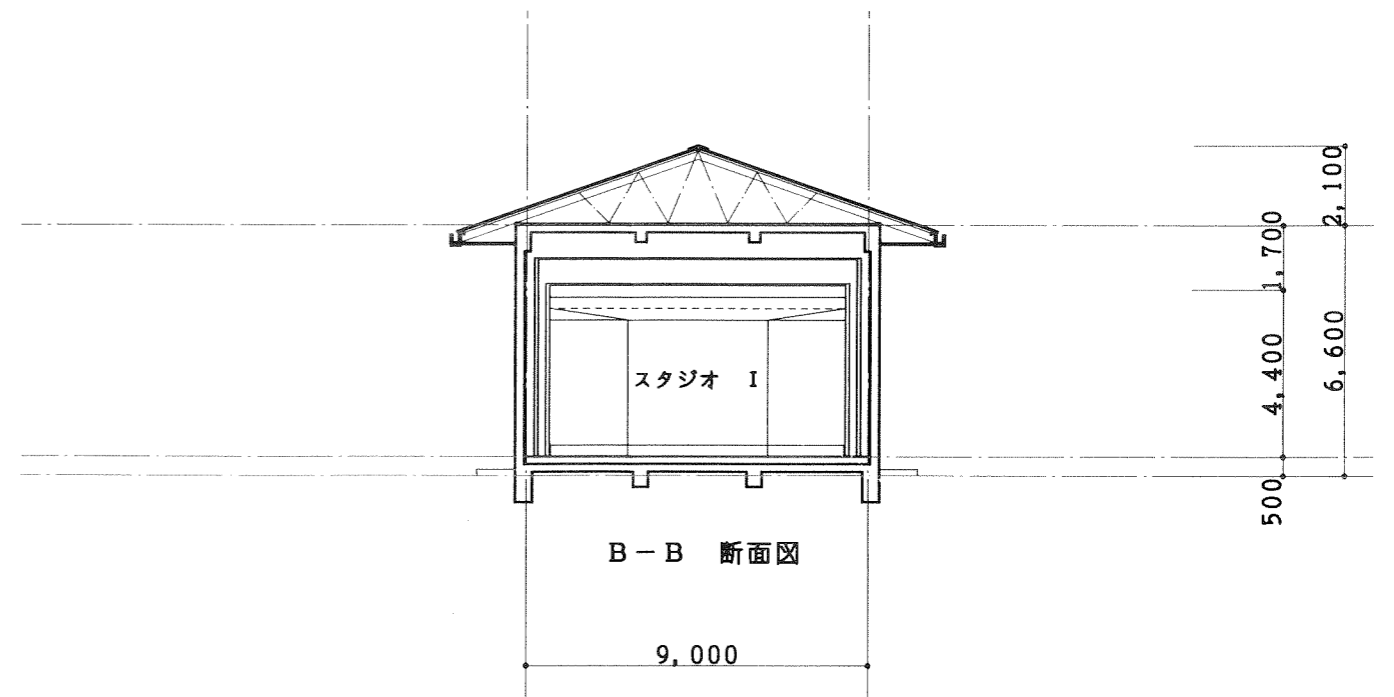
新スタジオ棟立面図 (2)・断面図 S=1/200
